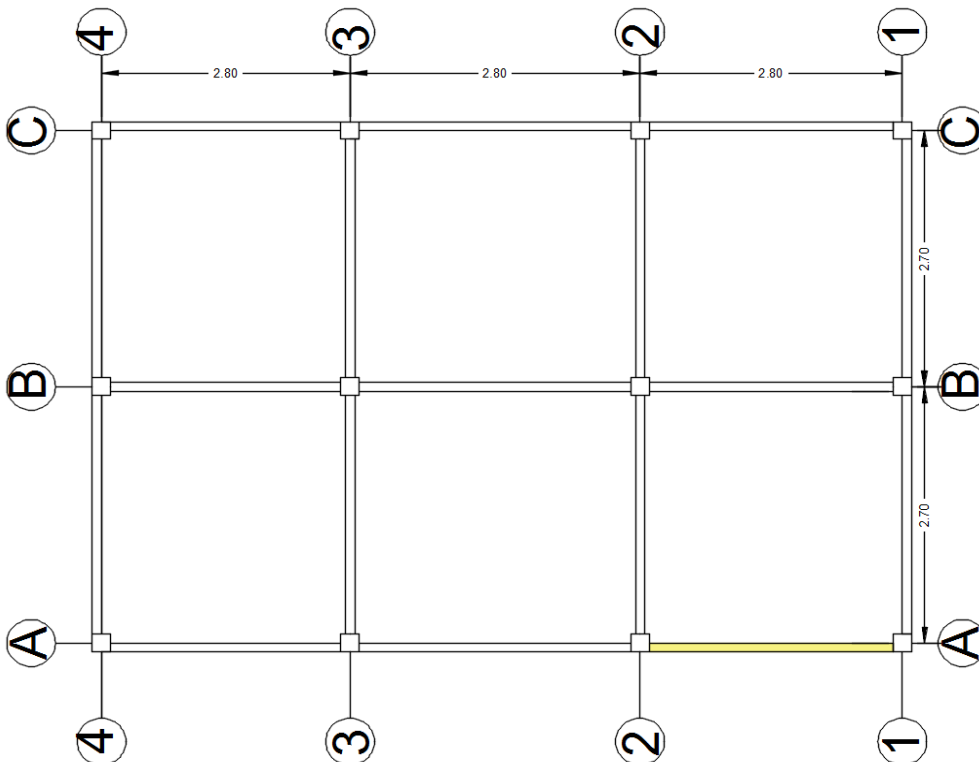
Vista en planta del eje donde se encuentra la pared a analizar
